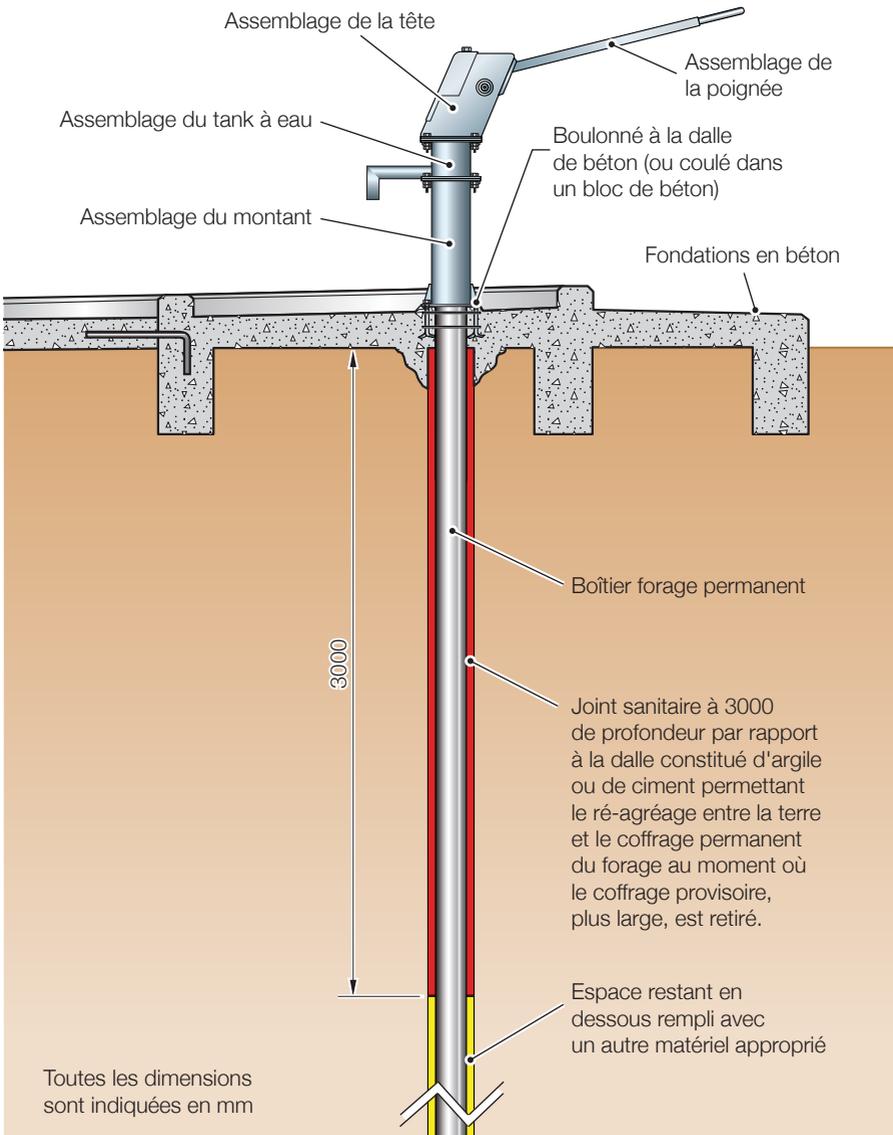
Un joint sanitaire, qui protège l'eau du forage d'une contamination
